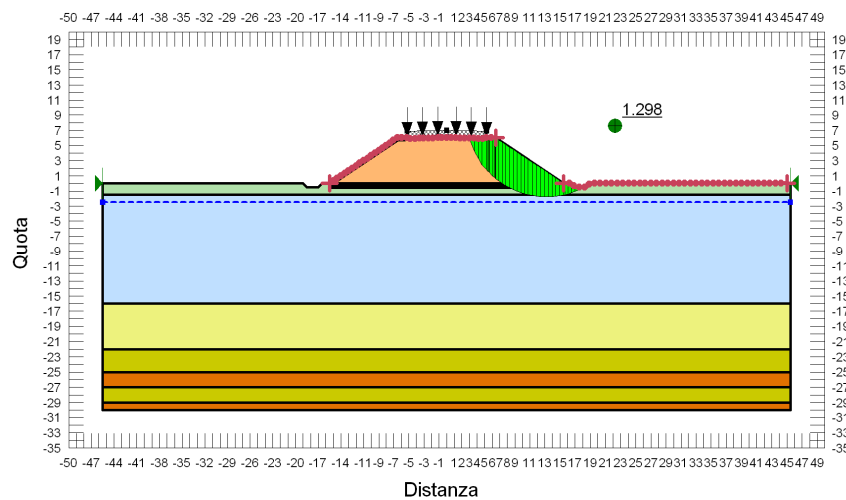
VERIFICA DI STABILITÀ GLOBALE RILEVATO DI H=6.00 M - CONDIZIONE STATICA DRENATA.
